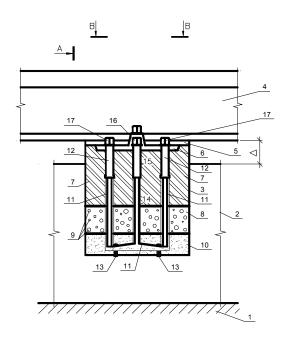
Разрез железнодорожного пути по фасаду рельса
